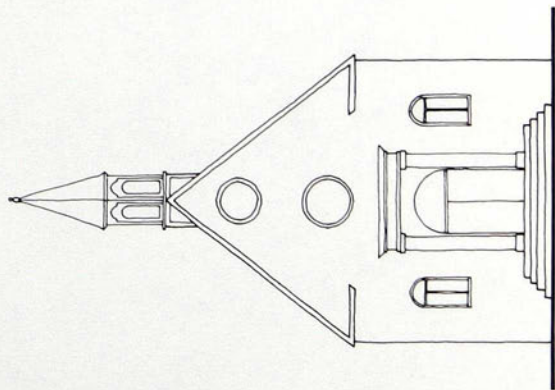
Façade de 1816. François Balllaïrgé, architecte.
